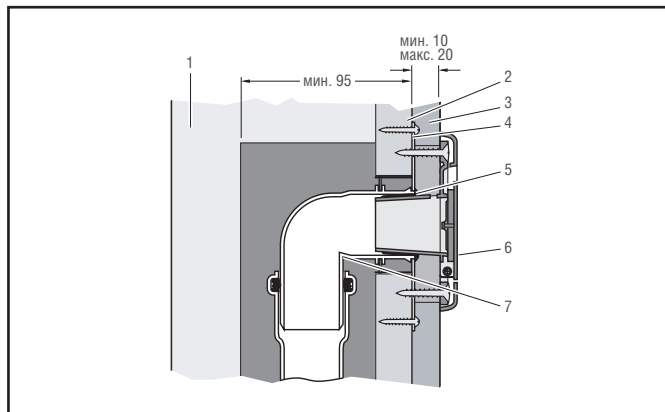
Монтаж в легких стеновых конструкциях. Вариант 1.
